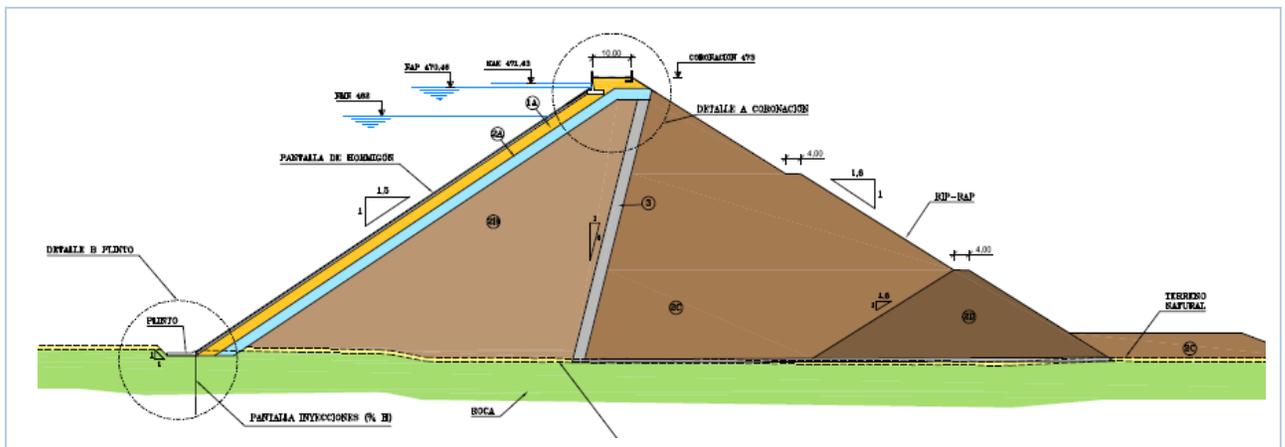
Sección tipo para la presa: materiales locales con pantalla de hormigón
